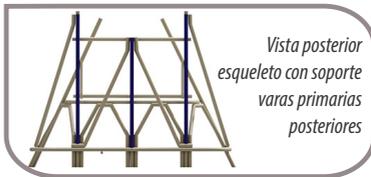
Imagen X Construcción soporte varas primarias posteriores, Elaboración propia.
